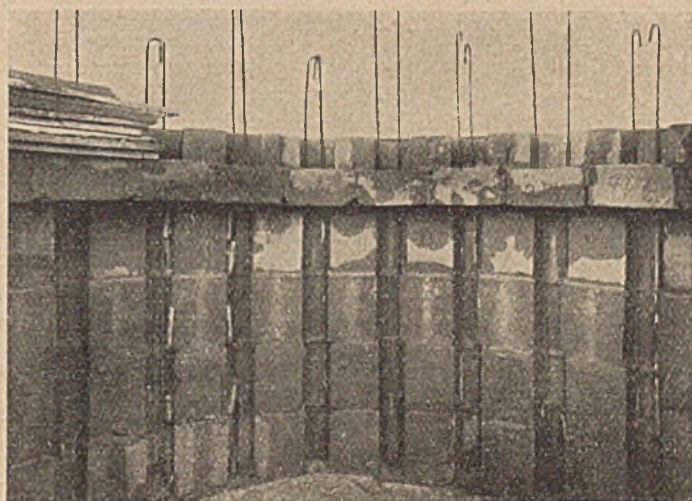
Wand aus einfachen Steinen im Bau mit Konsole.
